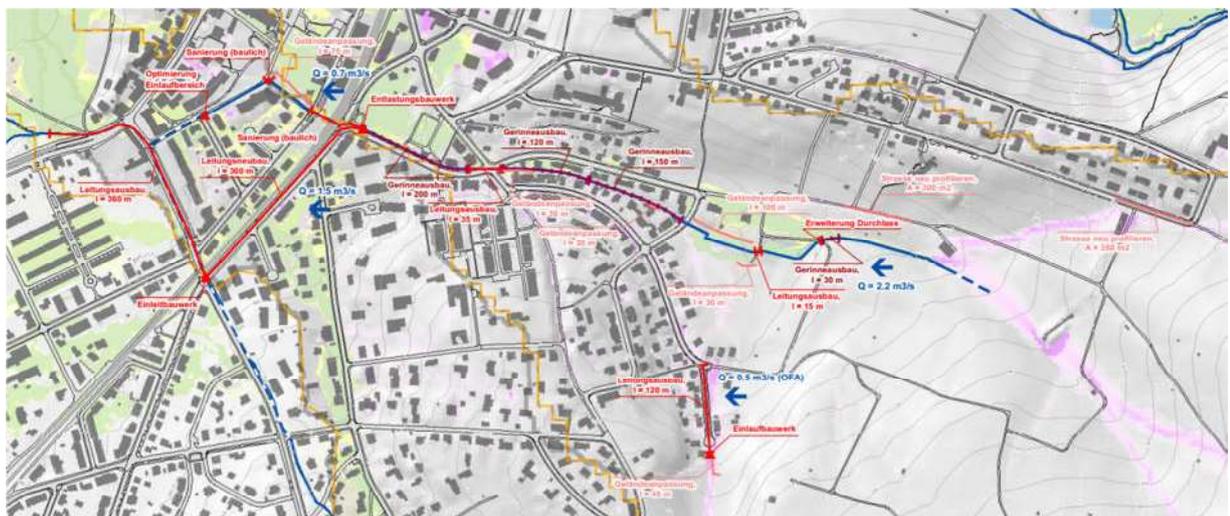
Ausschnitt aus dem Situationsplan Variante 2
